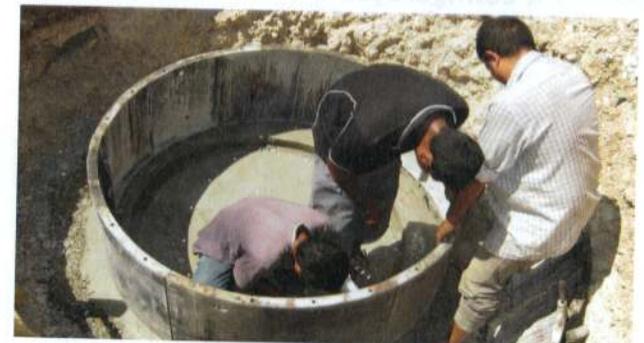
A : Montagem da parte interna do tanque PUXTIL
